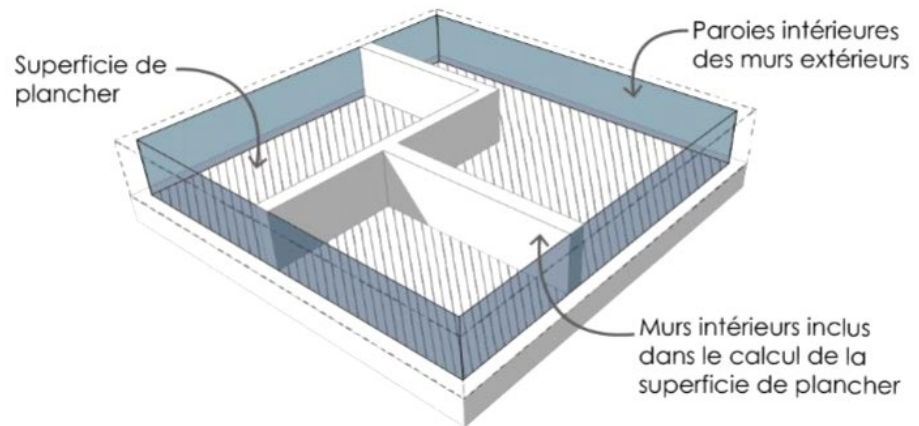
Mesure de la superficie de plancher d'un bâtiment
